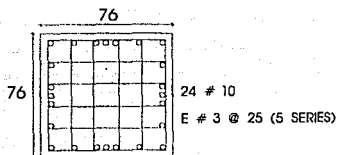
SECCION DE LAS COLUMNAS HASTA EL SEGUNDO NIVEL
